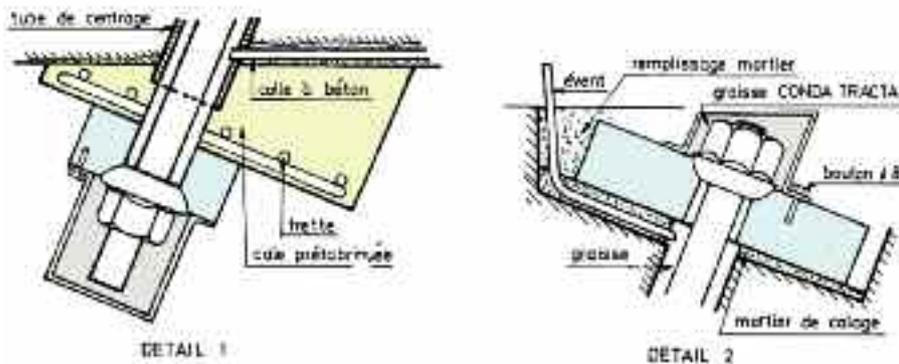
protection des têtes d'ancrage au viaduc de Saint-Isidore
